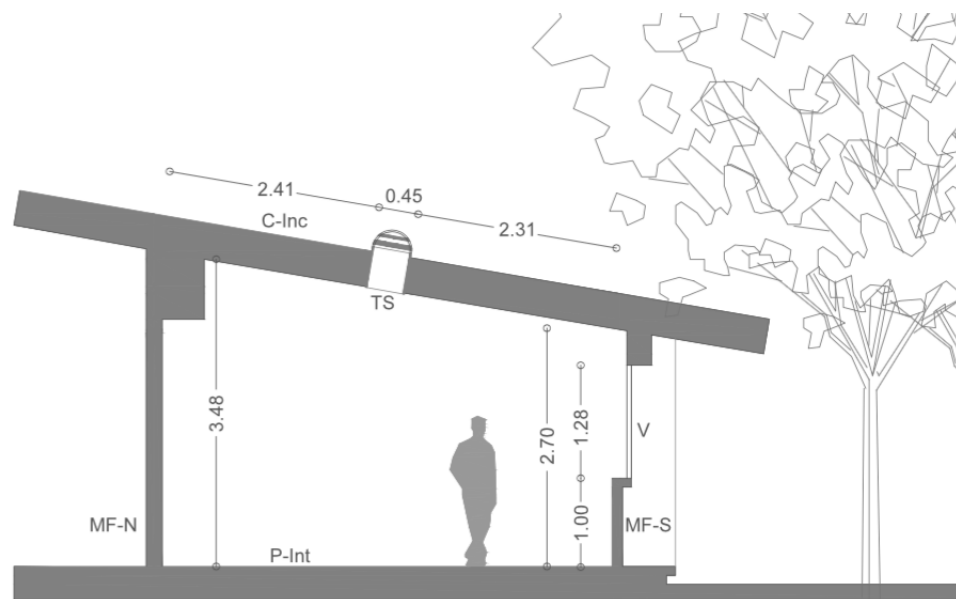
Corte (C-01) de la oficina de la dirección del IER-UNAM, donde TS es el tubo solar en la cubierta, V es ventana, MF-S es muro fachada sur, MF-N es muro fachada norte, C-Inc es cubierta inclinada, y P-Int es piso interior. Las cotas están en metros.
